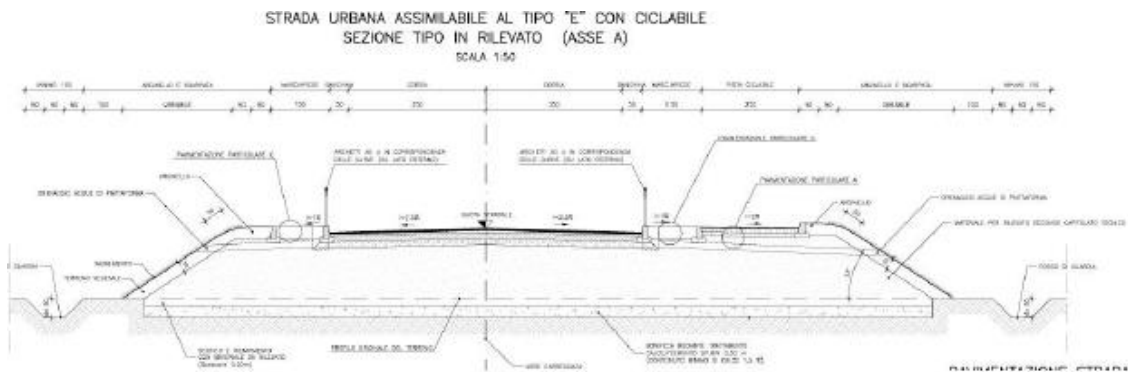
Sezione tipo stradale dell'asse principale di Progetto Esecutivo
